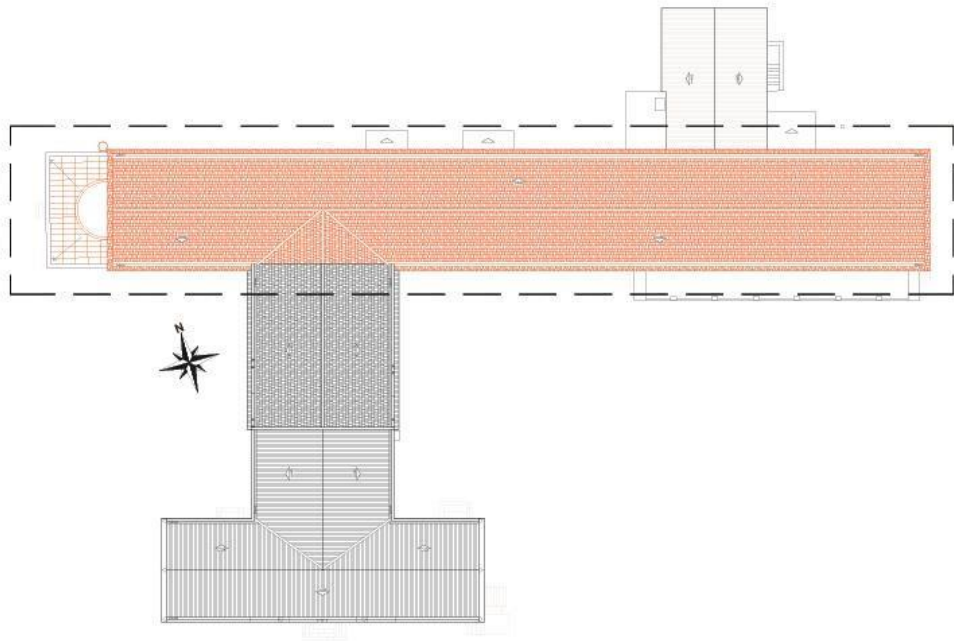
Planta de Cobertura – Área de Intervenção Etapa 2
